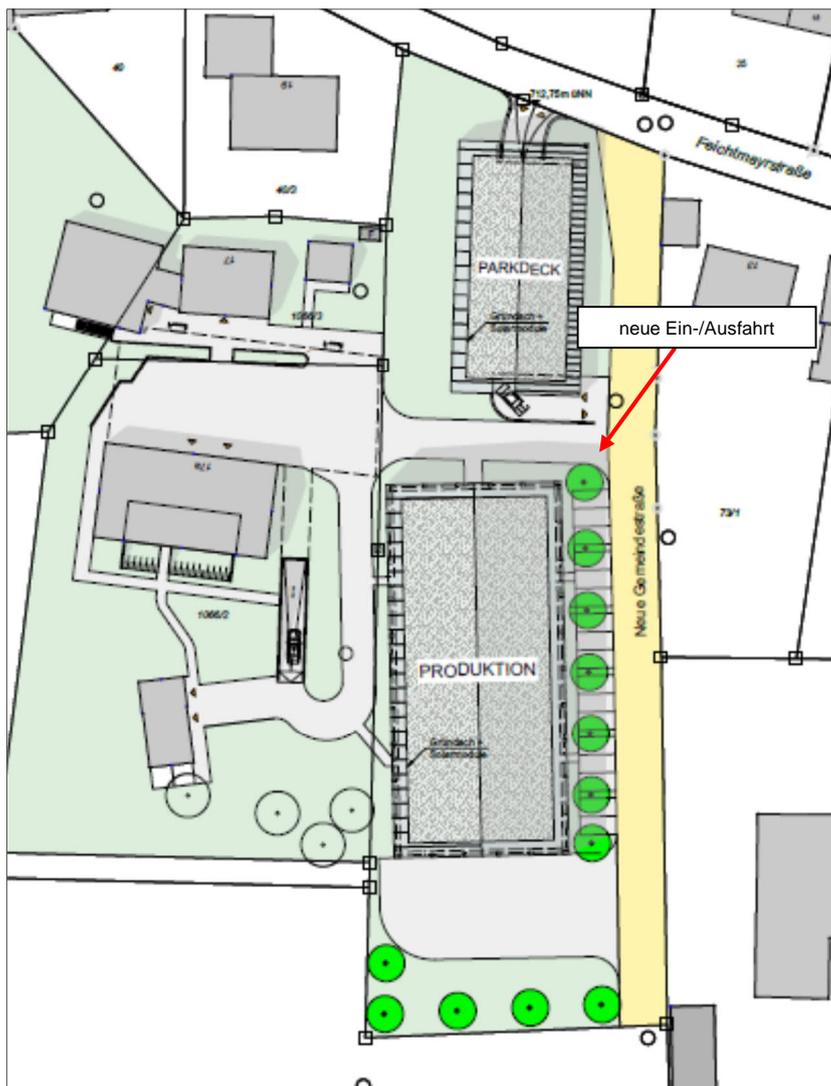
Ausschnitt Vorhaben- und Erschließungsplan - geplante Erweiterungen
